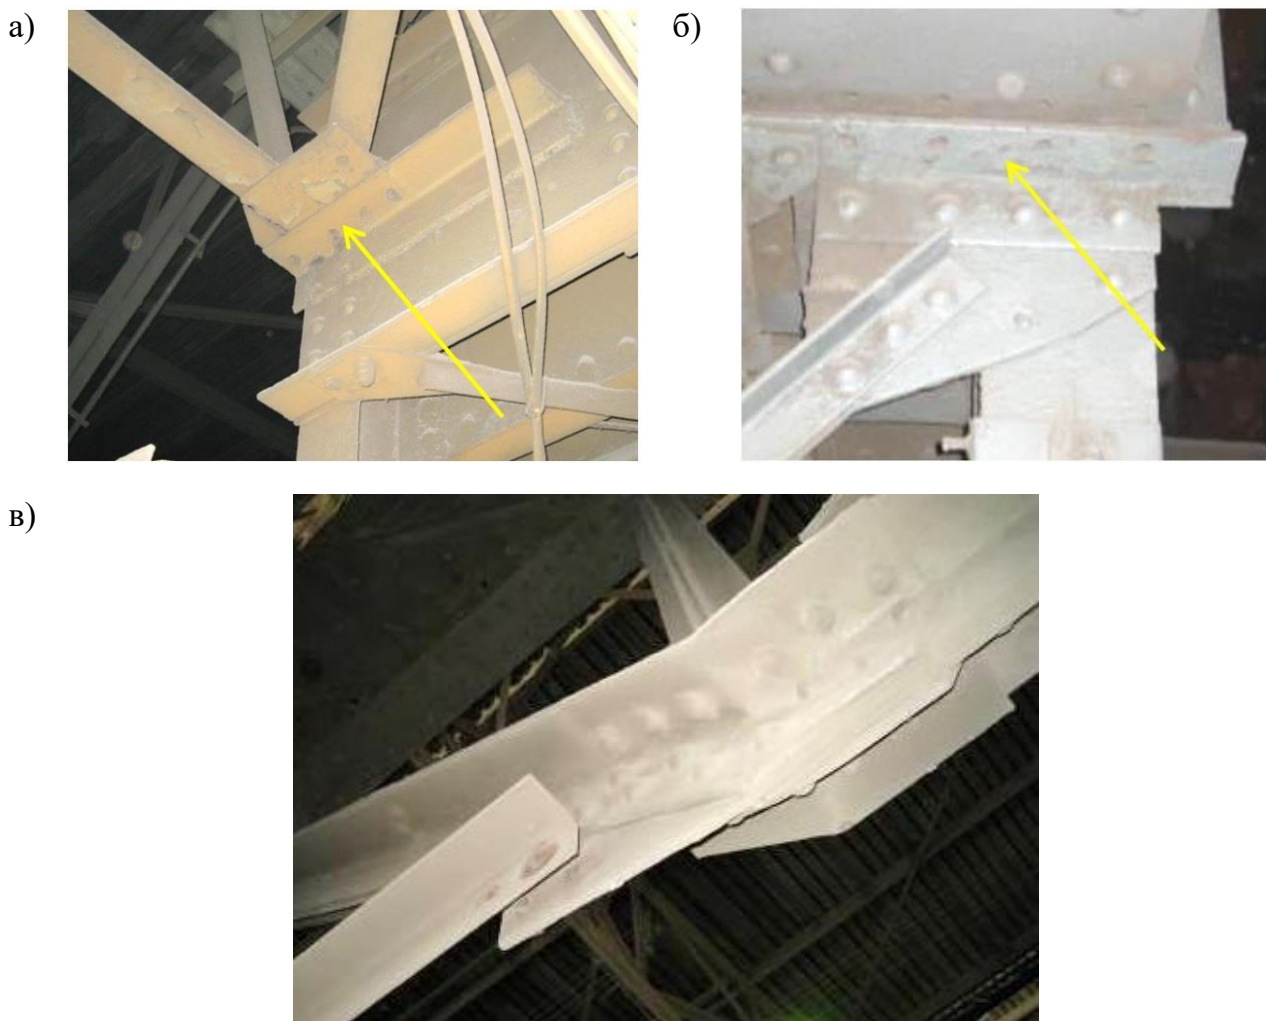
Срезавшиеся заклепки на колонне II-10 (а), на колонне II-16 (б) и в первом от оси 4 узле панели нижнего пояса подстропильной фермы (в)
